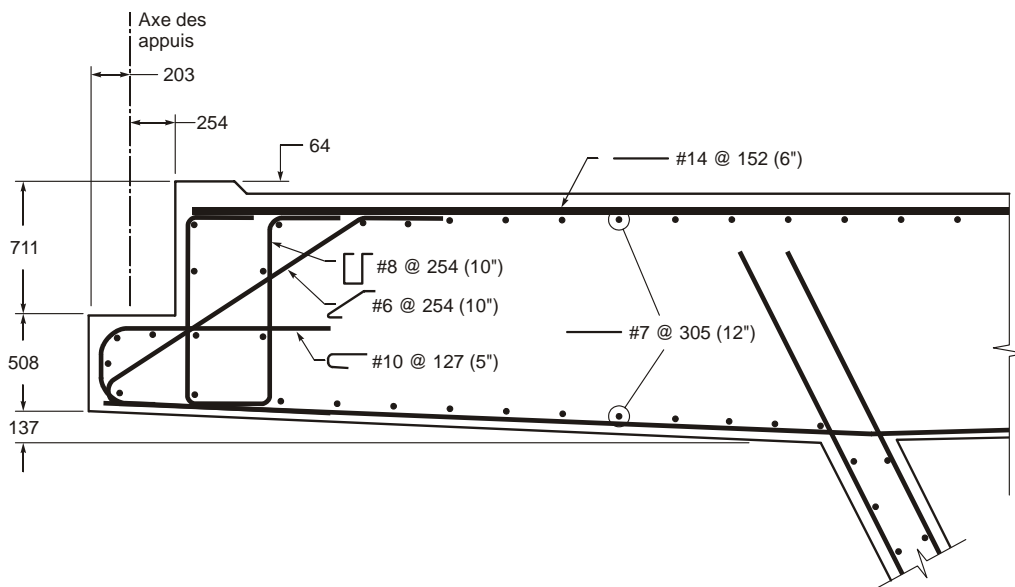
Armature de la dalle en porte-à-faux et détails de la chaise
